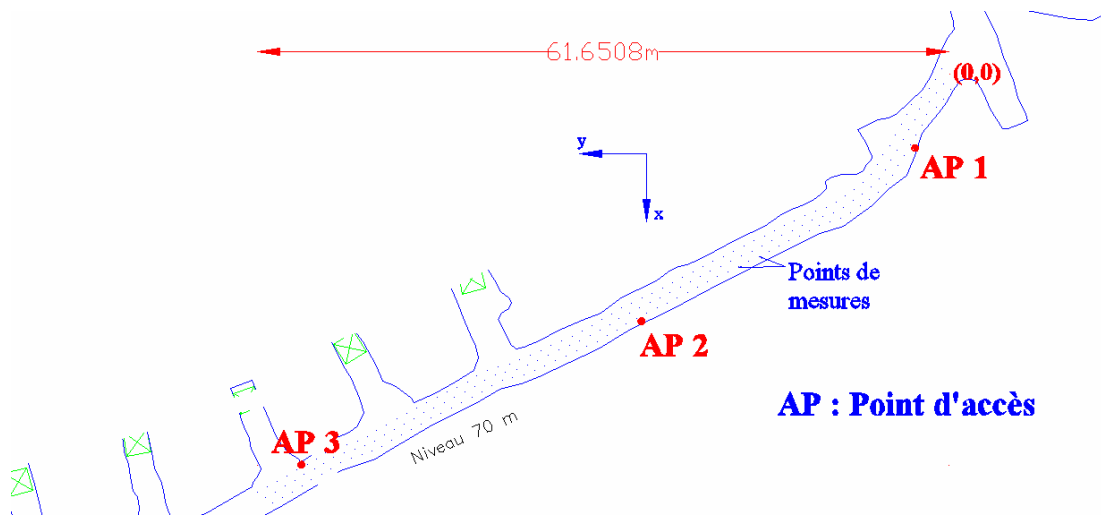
Plan de la galerie souterraine avec la position des points d'accès
